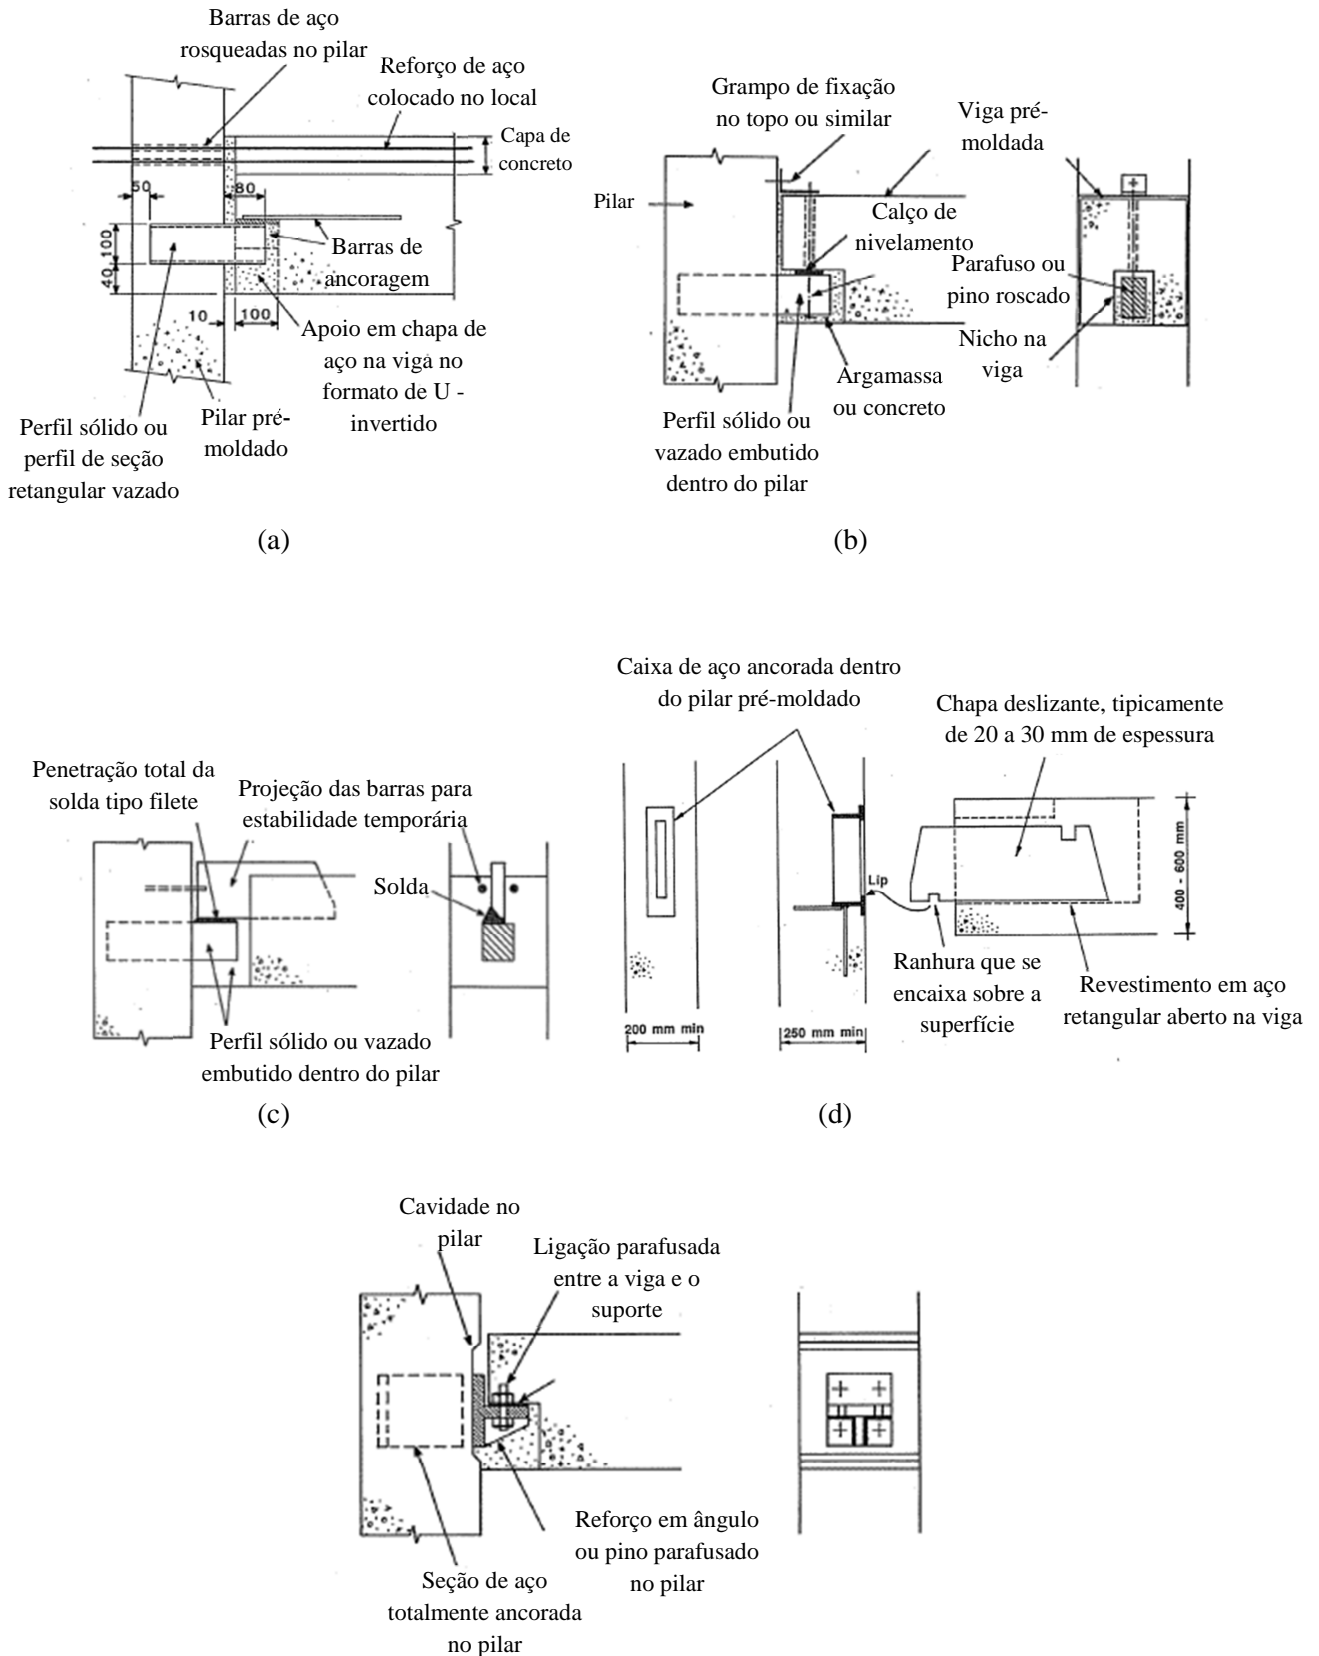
Exemplos de ligações viga-pilar utilizando consolo metálico [ELLIOT (1996)].
